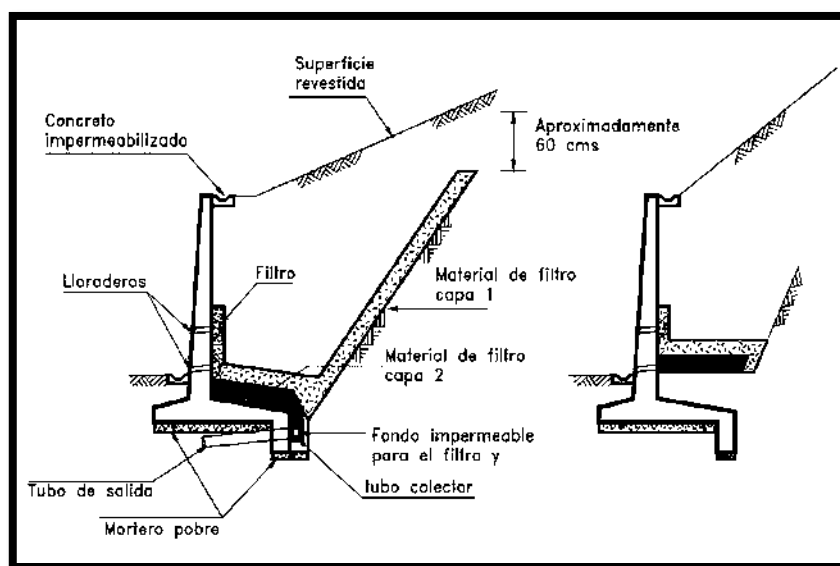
Subdrenaje de muro de contención (Suárez, 1998).
